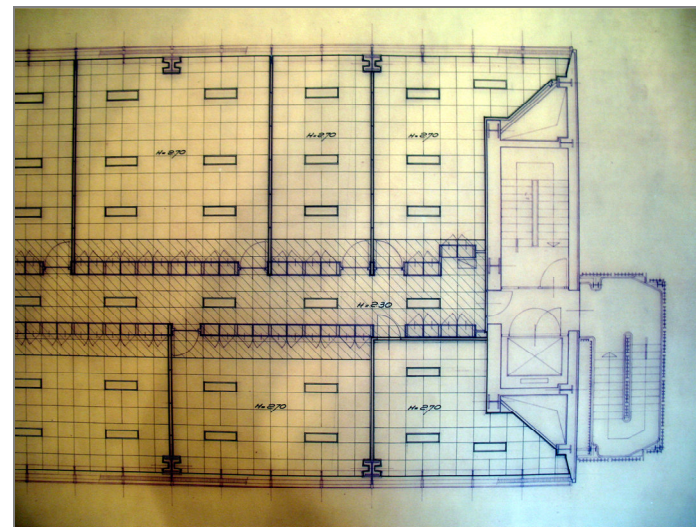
proposta di ristrutturazione generale - pianta piano secondo – controsoffitto e disposizione lampade (fonte CSAC , stralcio tav. 19, archivio n. 371-2)
